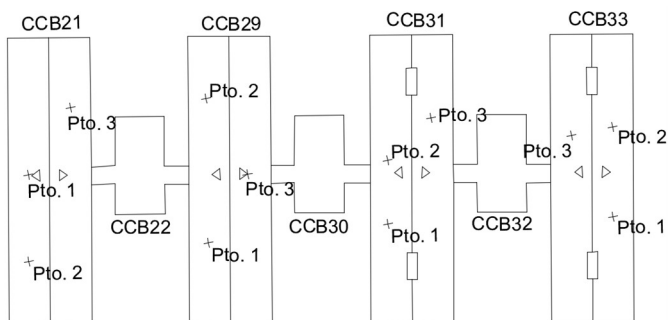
Planta da cobertura das edificações (CCB-MIP) com características das edificações – Local 3.
